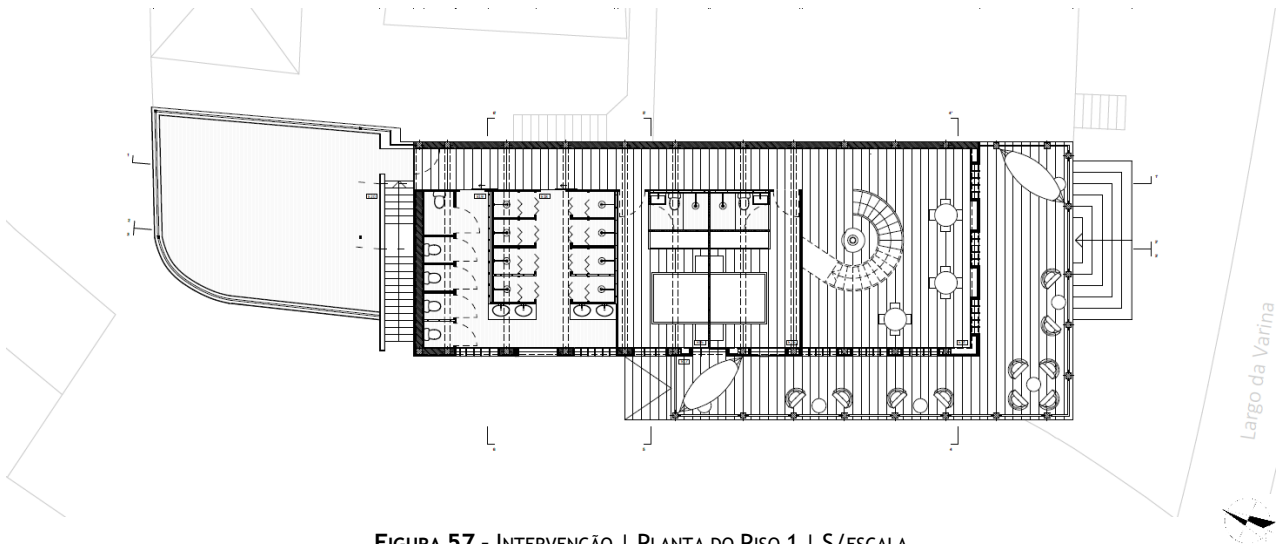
INTERVENÇÃO | PLANTA DO PISO 1 | S/ESCALA
